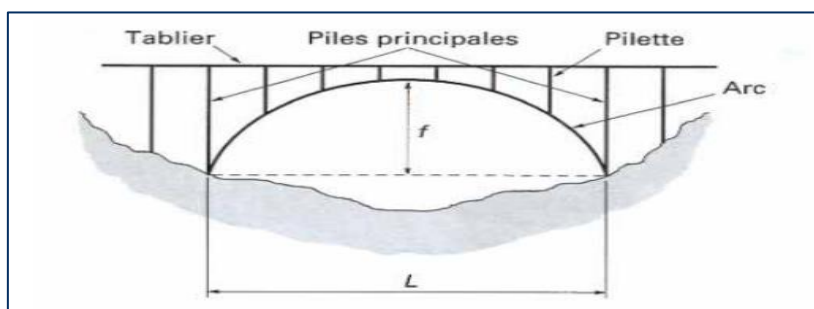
Schéma d'un pont en arc à tablier supérieur
